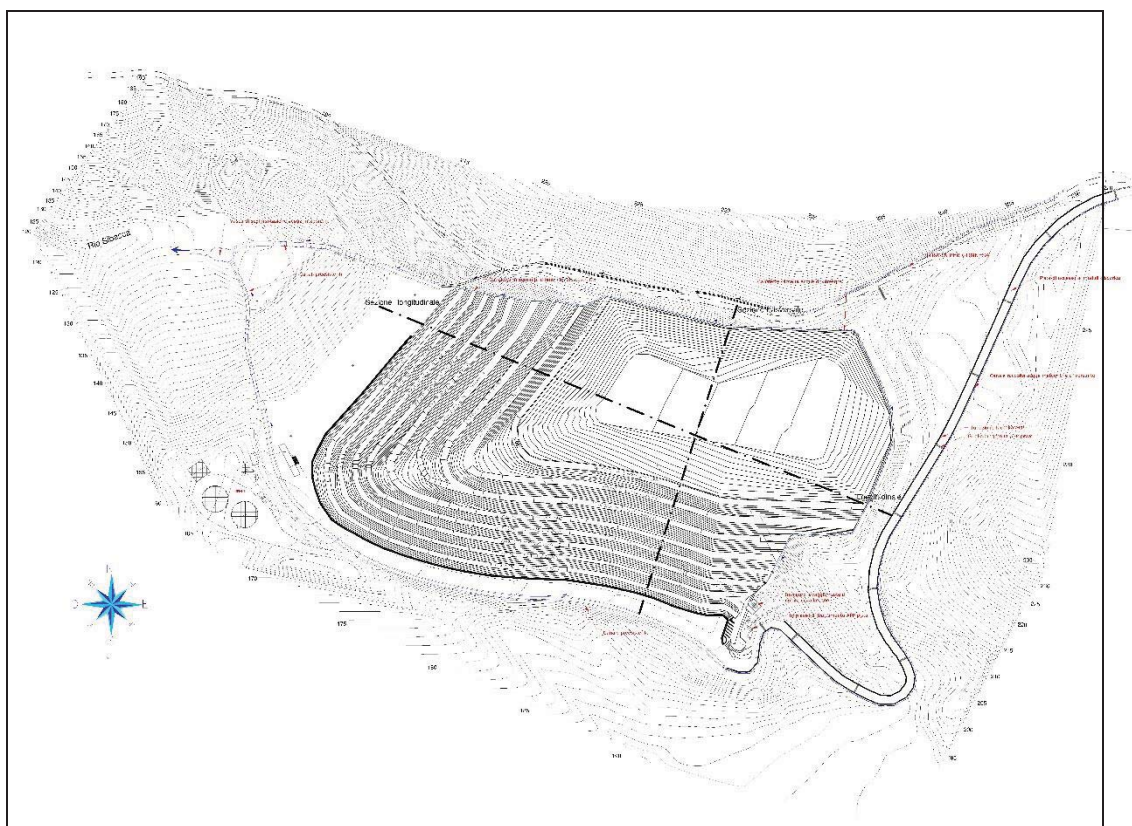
Planimetria della discarica in progetto (ottavo argine)
